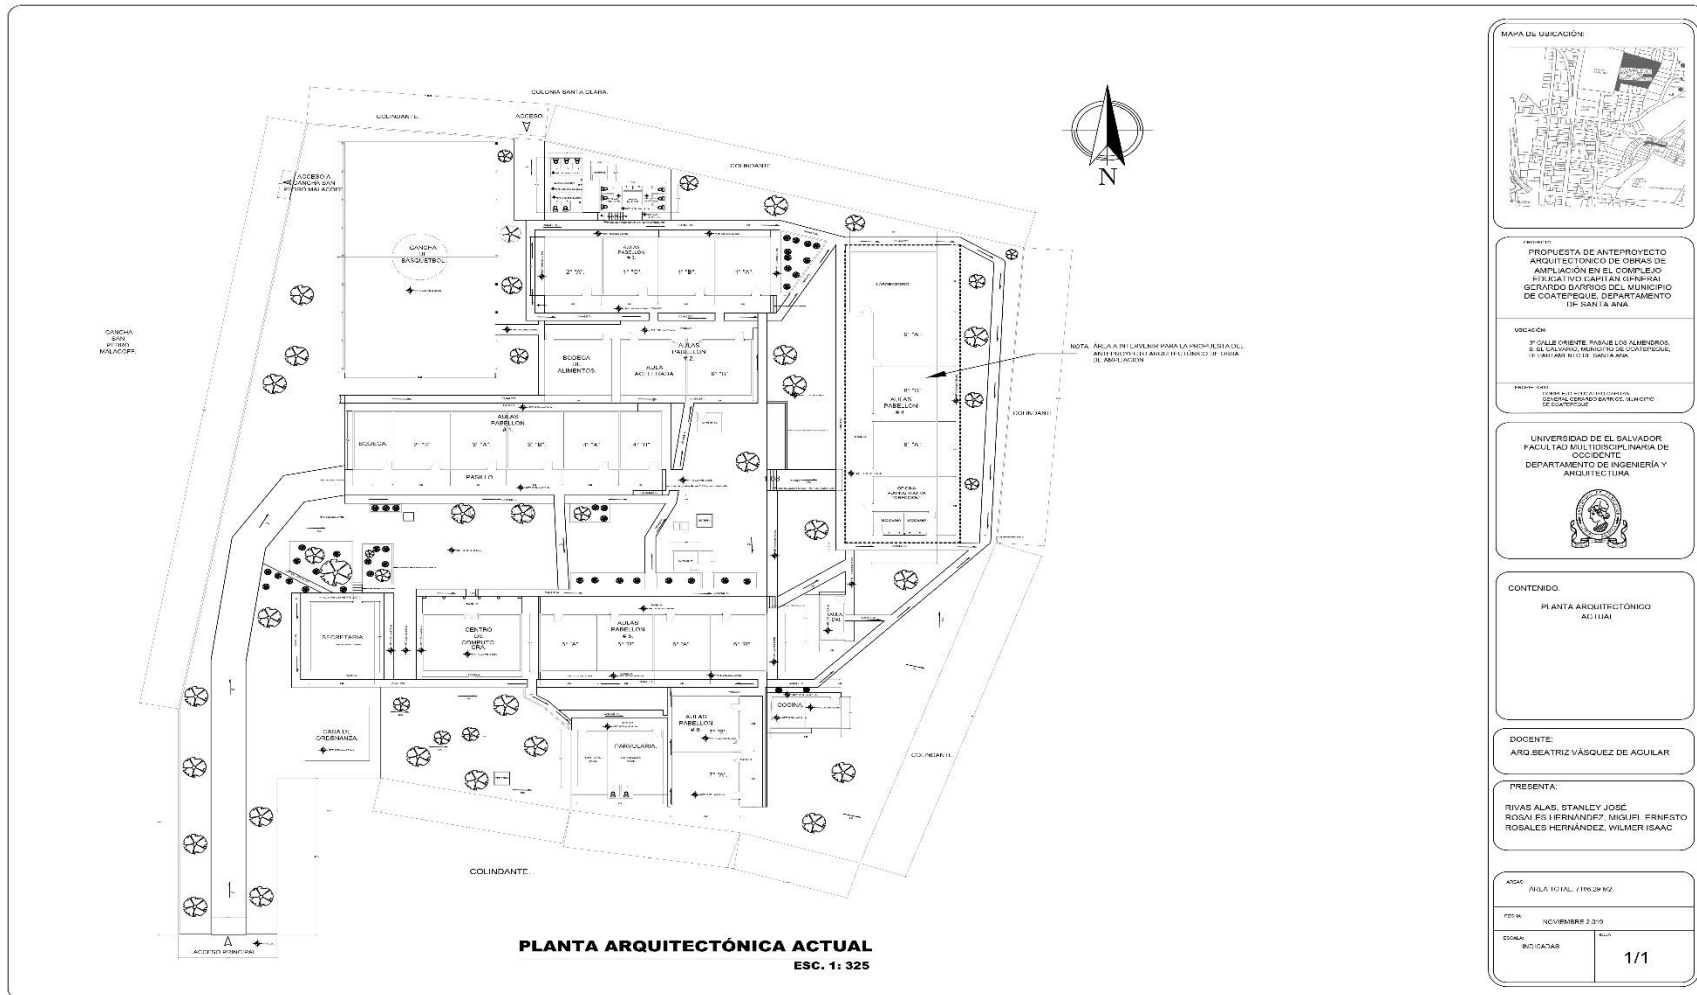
PLANTA ARQUITECTÓNICA ACTUAL DEL C.E.C.G.G.B.
